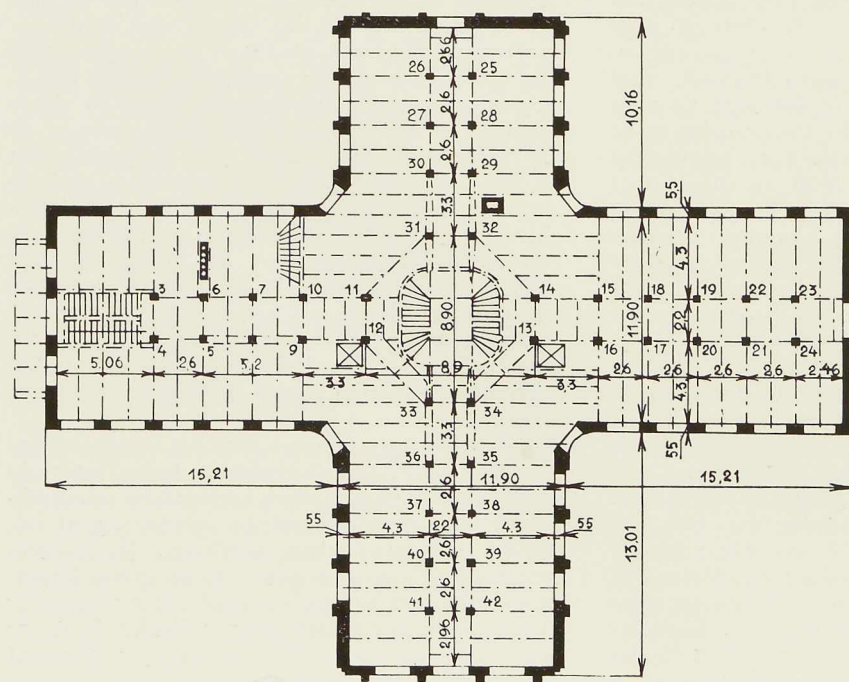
Plan du bâtiment et disposition des colonnes, poutres longitudinales et solives de l'ossature métallique.
